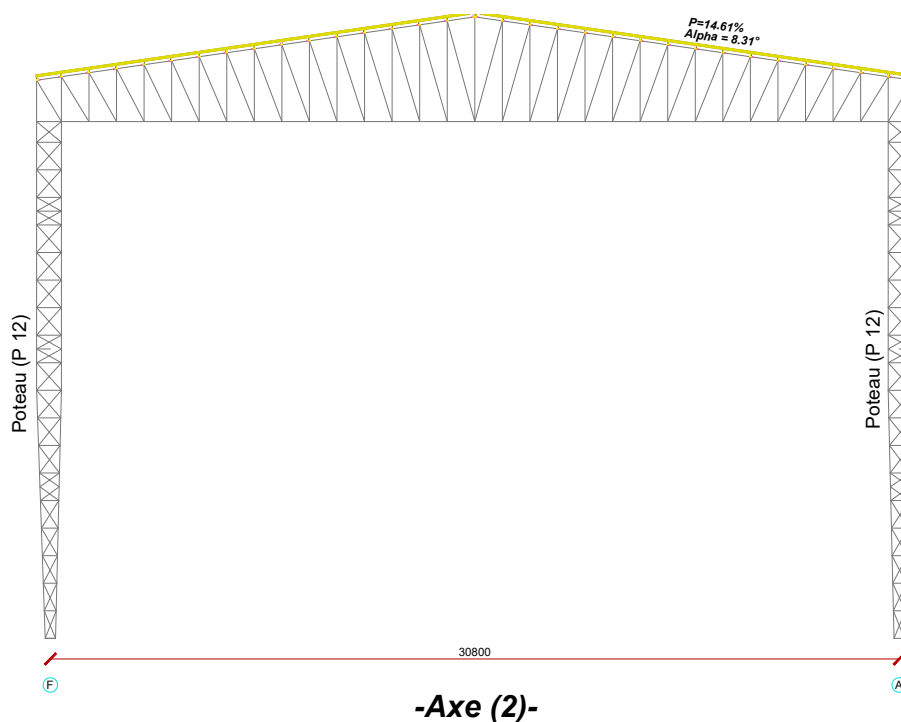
Portique principal constitué d'une ferme treillis de type HOWE et de poteaux treillisés tubulaires.
